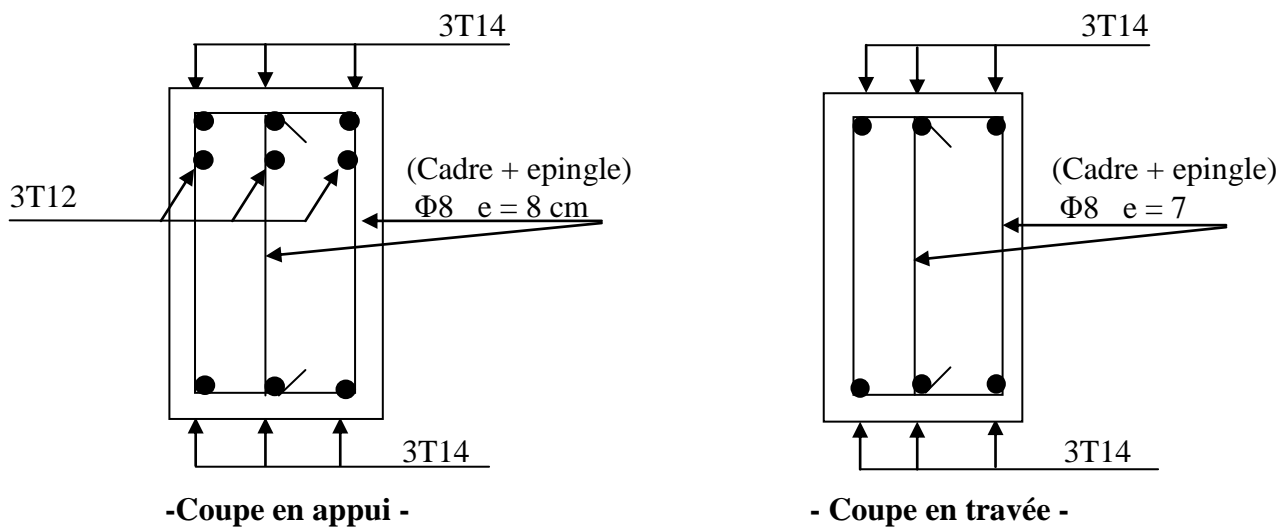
Schéma de ferrailage pour la poutre secondaire en travée et en appui
